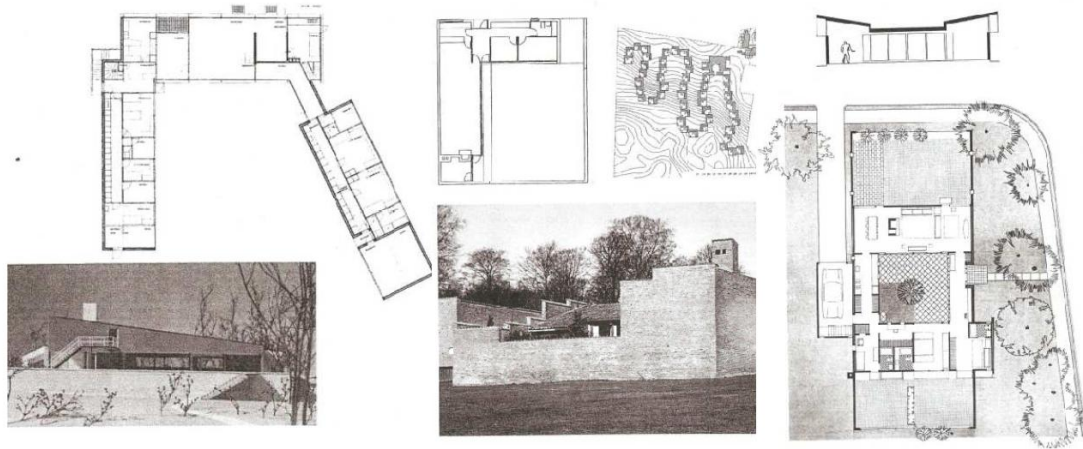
(esq.) Arne Jacobsen, planta e vista da casa Jürgensen, Vedbaek, Copenhaga, Dinamarca; (ao centro) Jørn Utzon, planta de uma das casas, planta do conjunto e vista exterior das casas Kingo, Helsingør, Dinamarca; (dir.) Josep Lluís Sert, secção e planta da casa-pátio em Cambridge, Estados Unidos. (Capitel, 2005, pp. 180, 185, 190)
